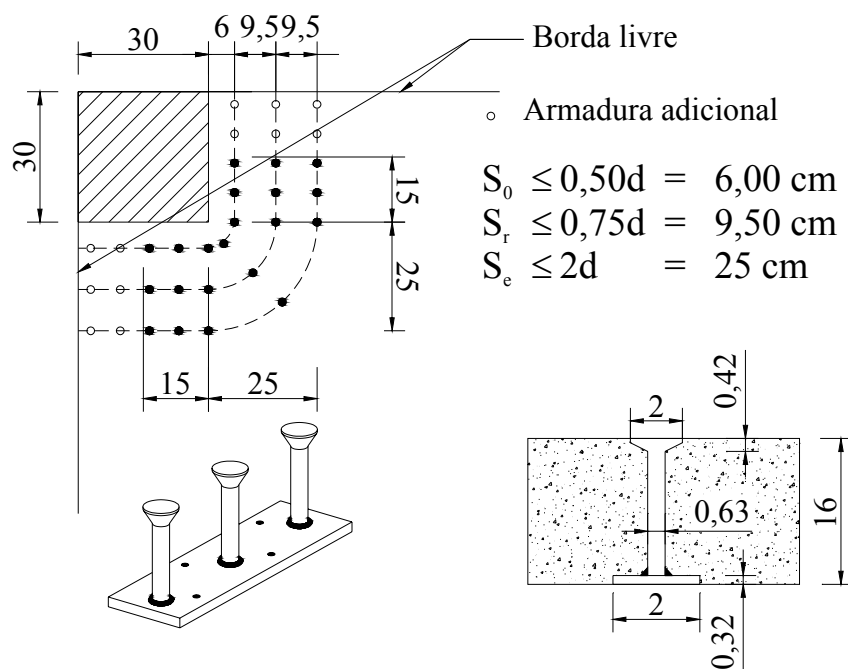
12 Arranjo da armadura de punção para o pilar P4
